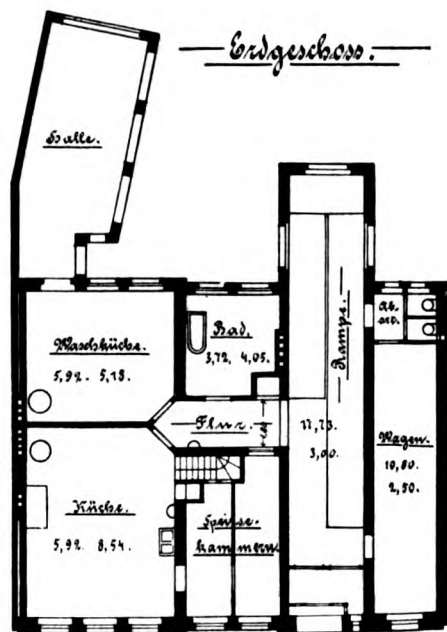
7. Agnes-Krippe; Grundrisse.
